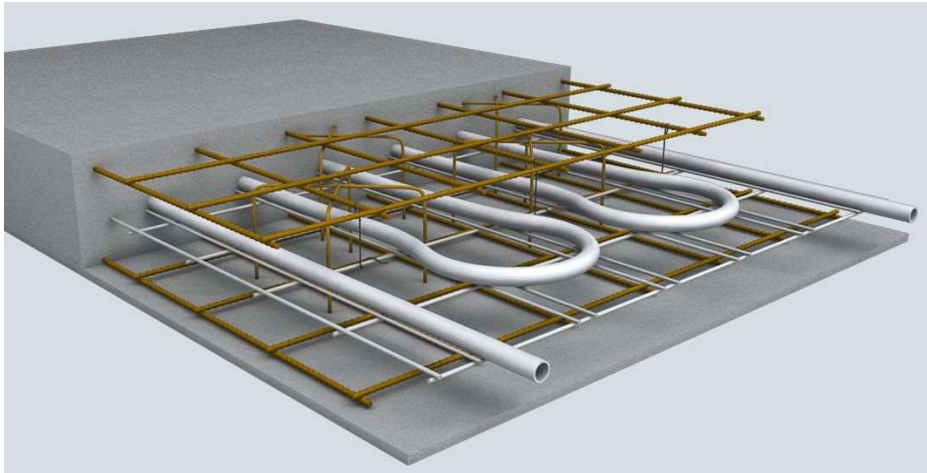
Modell einer aktivierten Betondecke - das Rohrsystem ist zentral im Bauteil montiert (@ Uponor)
